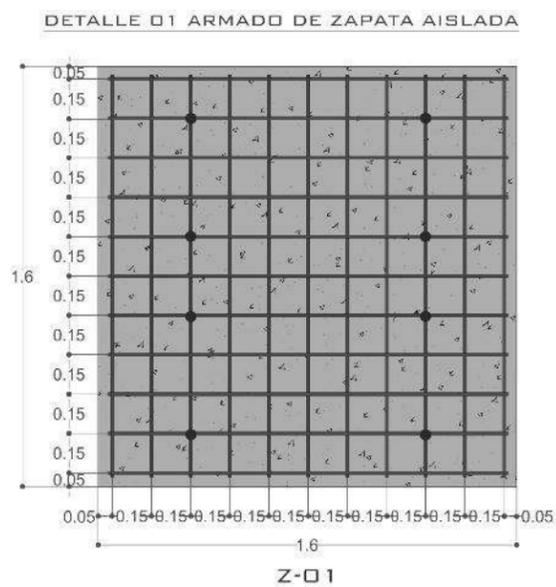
Detalle de zapata aislada creada editada por el autor. Software AutoCad+Photoshop
